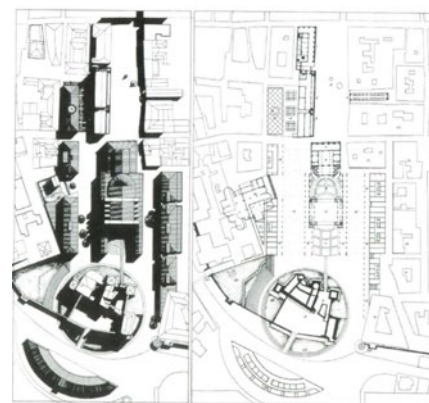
Planivolumetrico e planimetria del progetto Natalini per la riqualificazione di piazza Malatesta e la ricostruzione del teatro Galli ad essa prospiciente.
